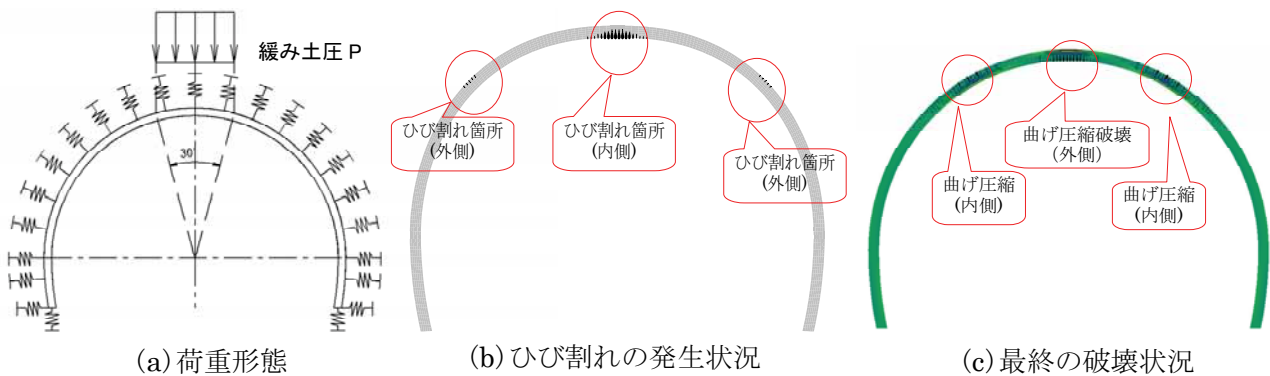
緩み土圧が作用する場合のひび割れ図および変形図
